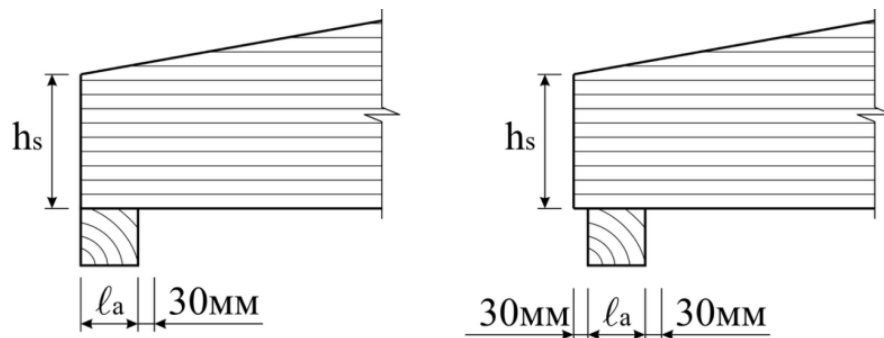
Схеми опирання балки на колону
